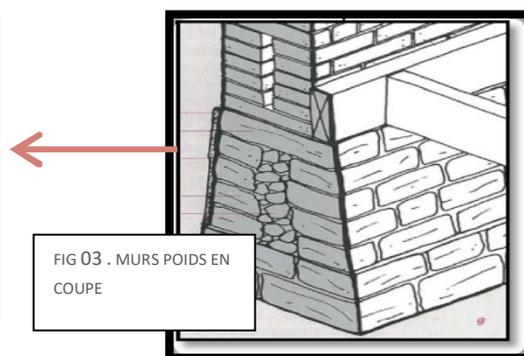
COUPE SUR UNE FONDATION EN PIERRE .SOURCE . AUTEUR
